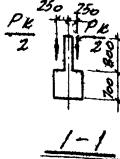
СХЕМА ИСПЫТАНИЯ БАЛОК
